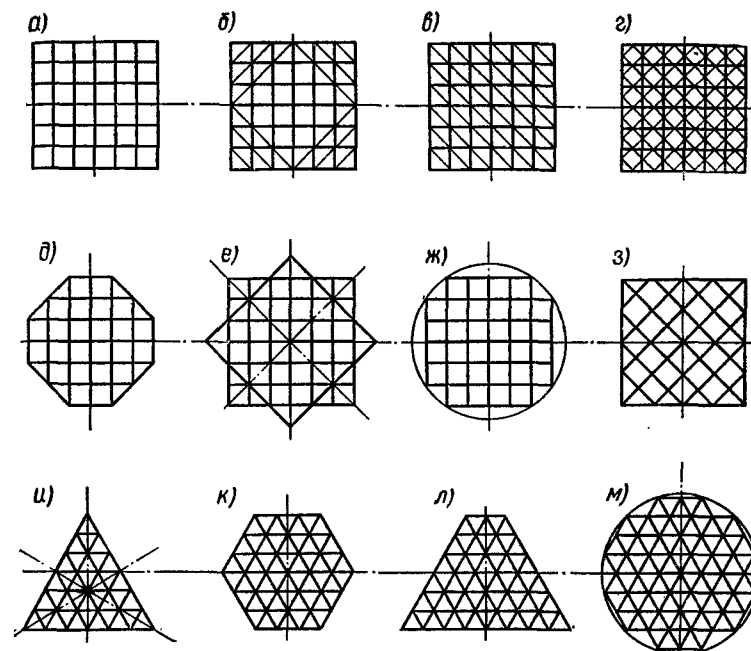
Основные схемы покрытий (а—м) из вертикальных перекрестных балок и ферм
